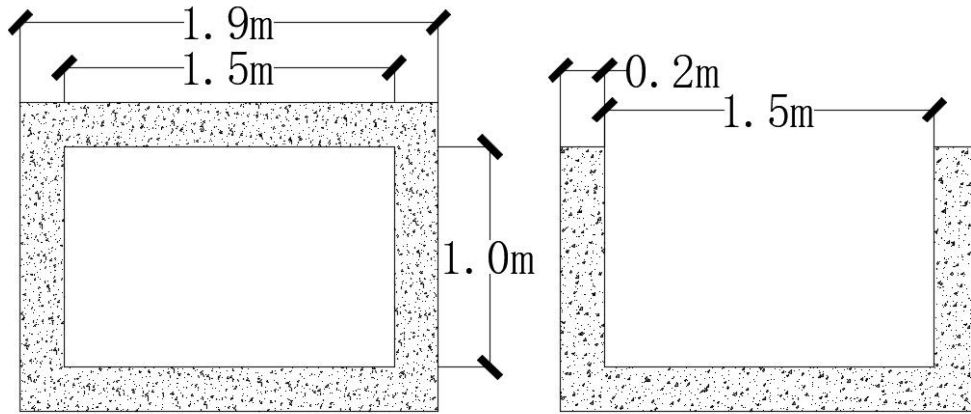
沉砂池大样图 (C20 混凝土现浇)
